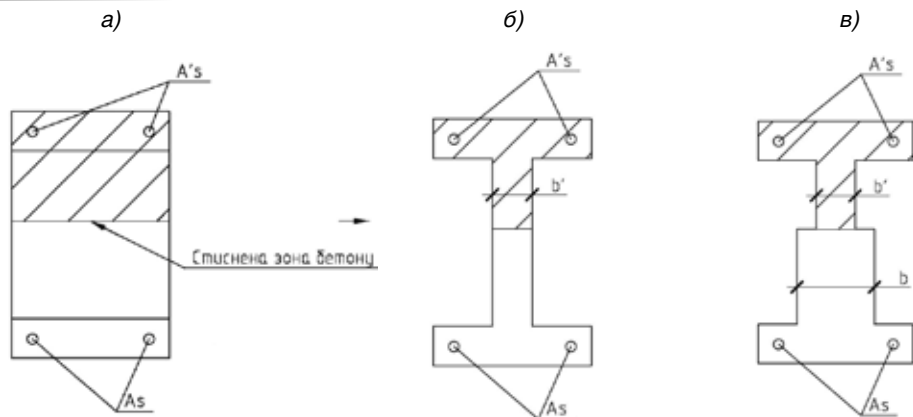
Поперечные сечения трехслойного железобетонного элемента:
